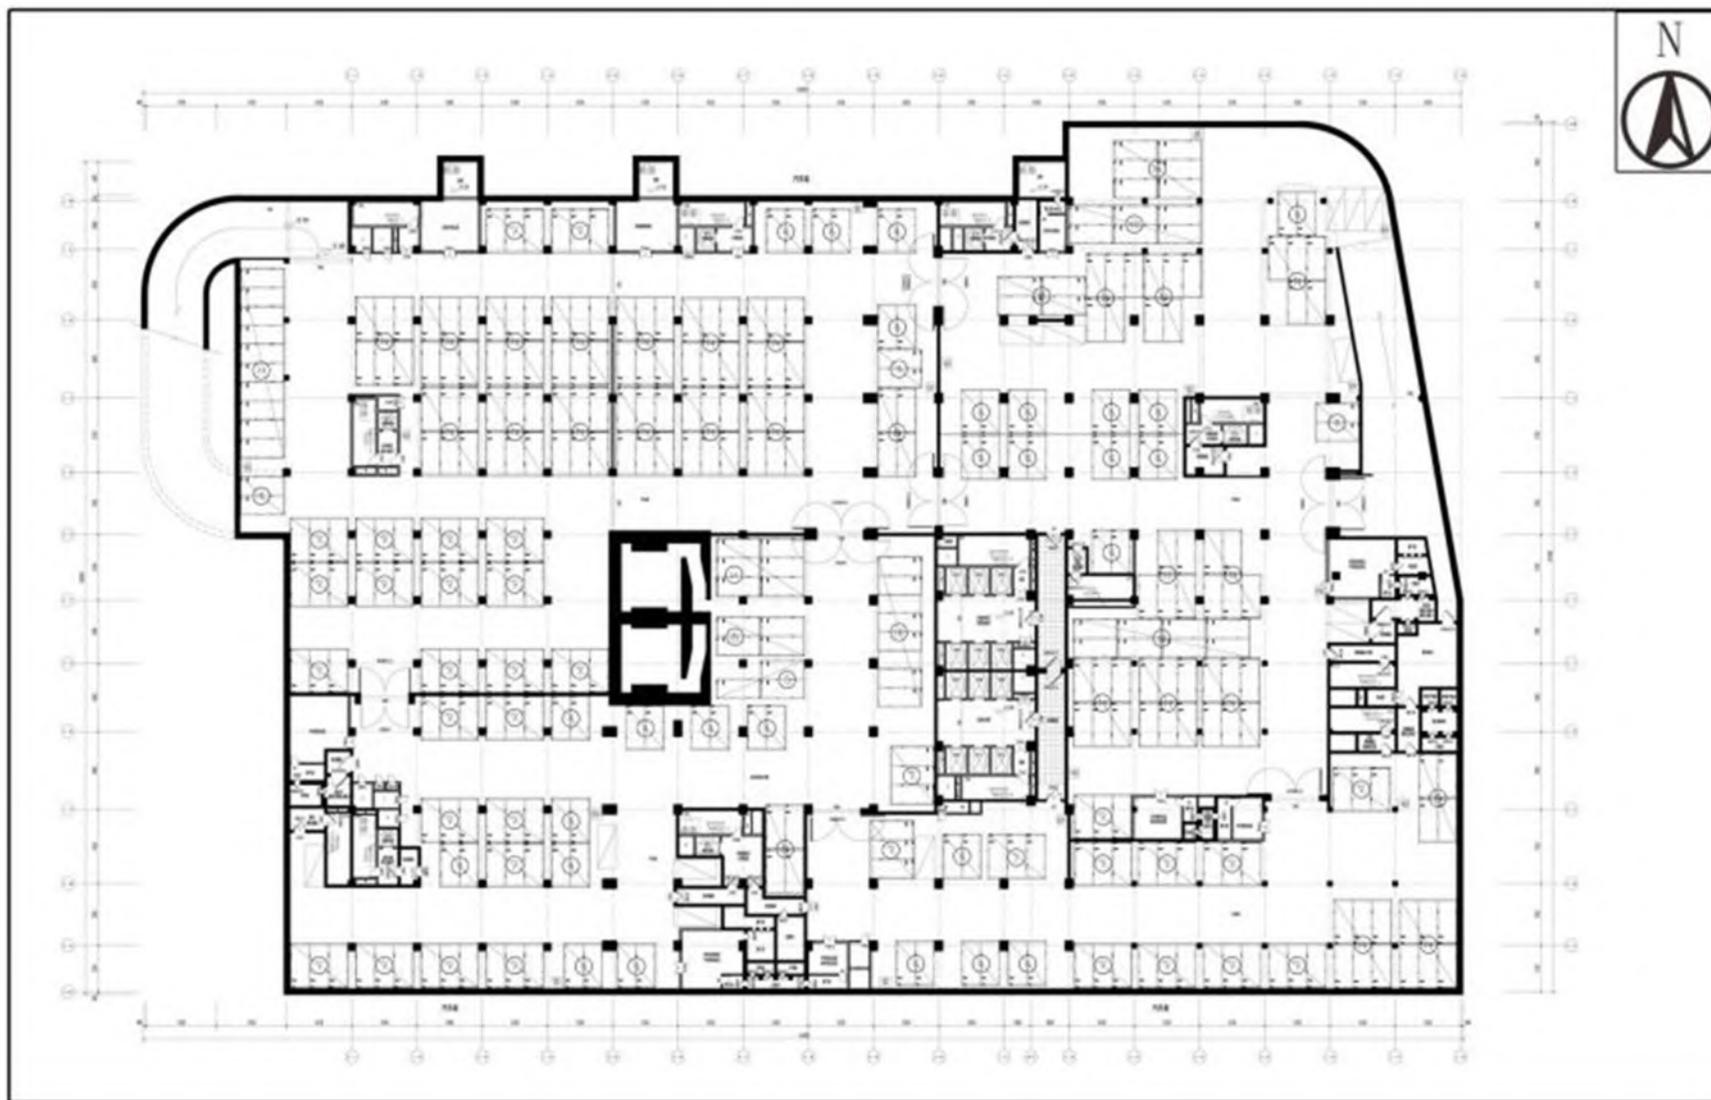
本项目医技病房楼地下四层平面布置图（平时）
